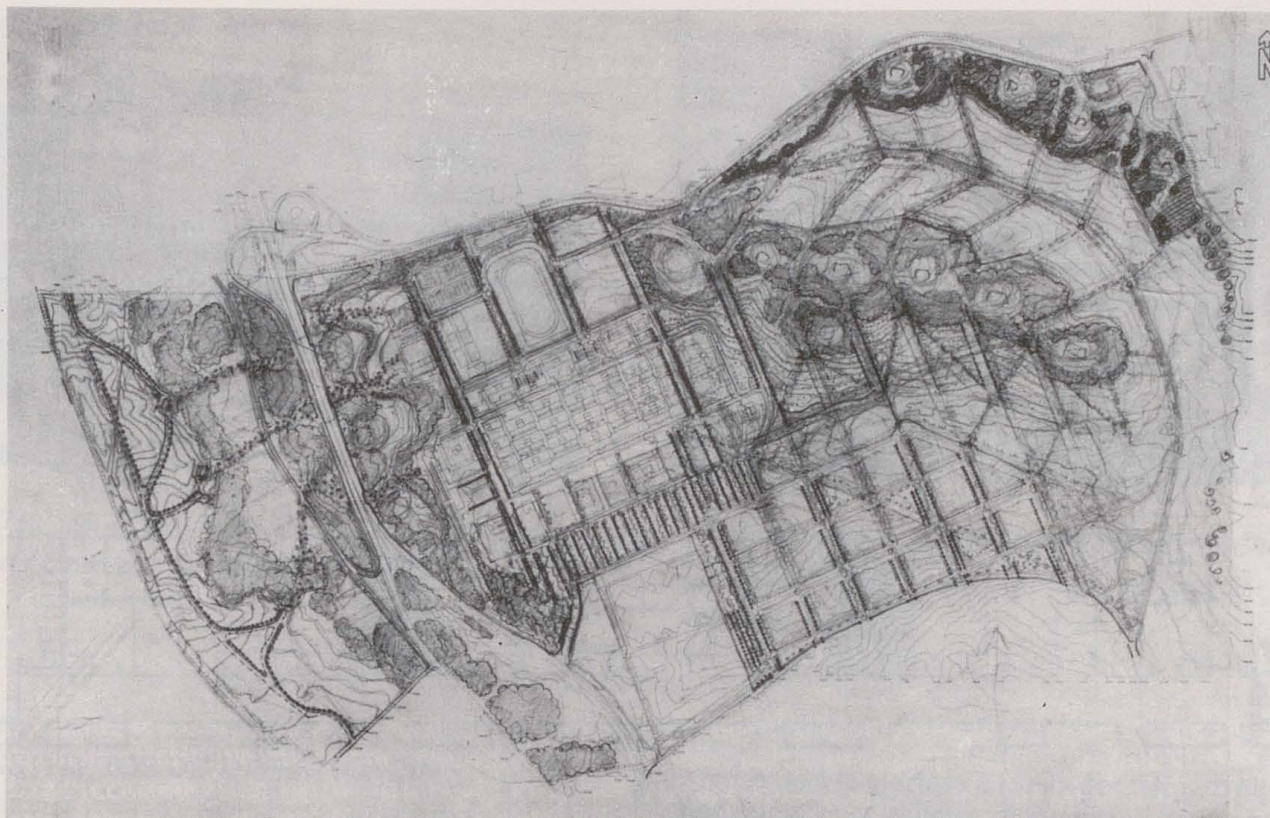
Equipo Ferrán: Propuesta de ensanche para la Universidad.
